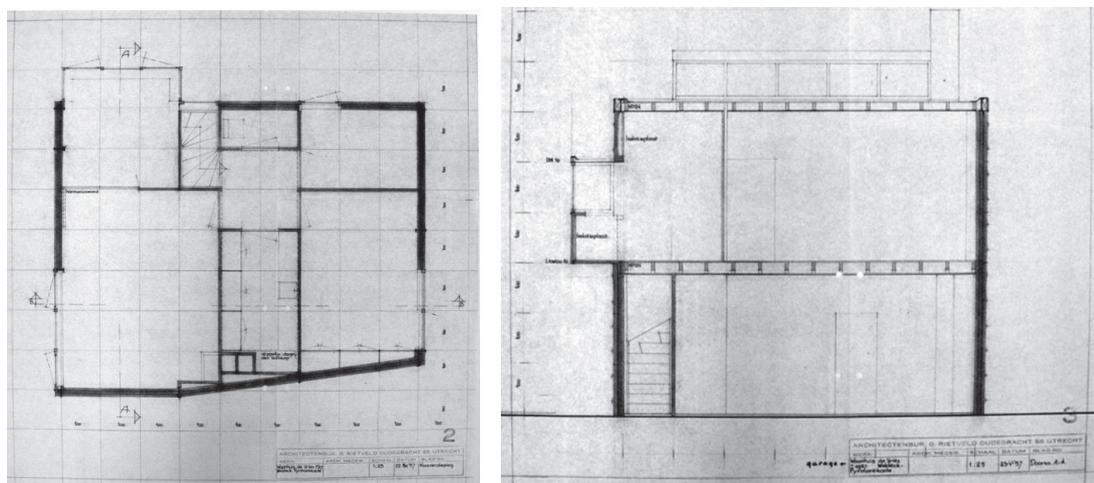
Dibujos originales de la planta primera y sección de la vivienda para el chófer sobre el garaje, diseñada por Gerrit Rietveld en 1927.
